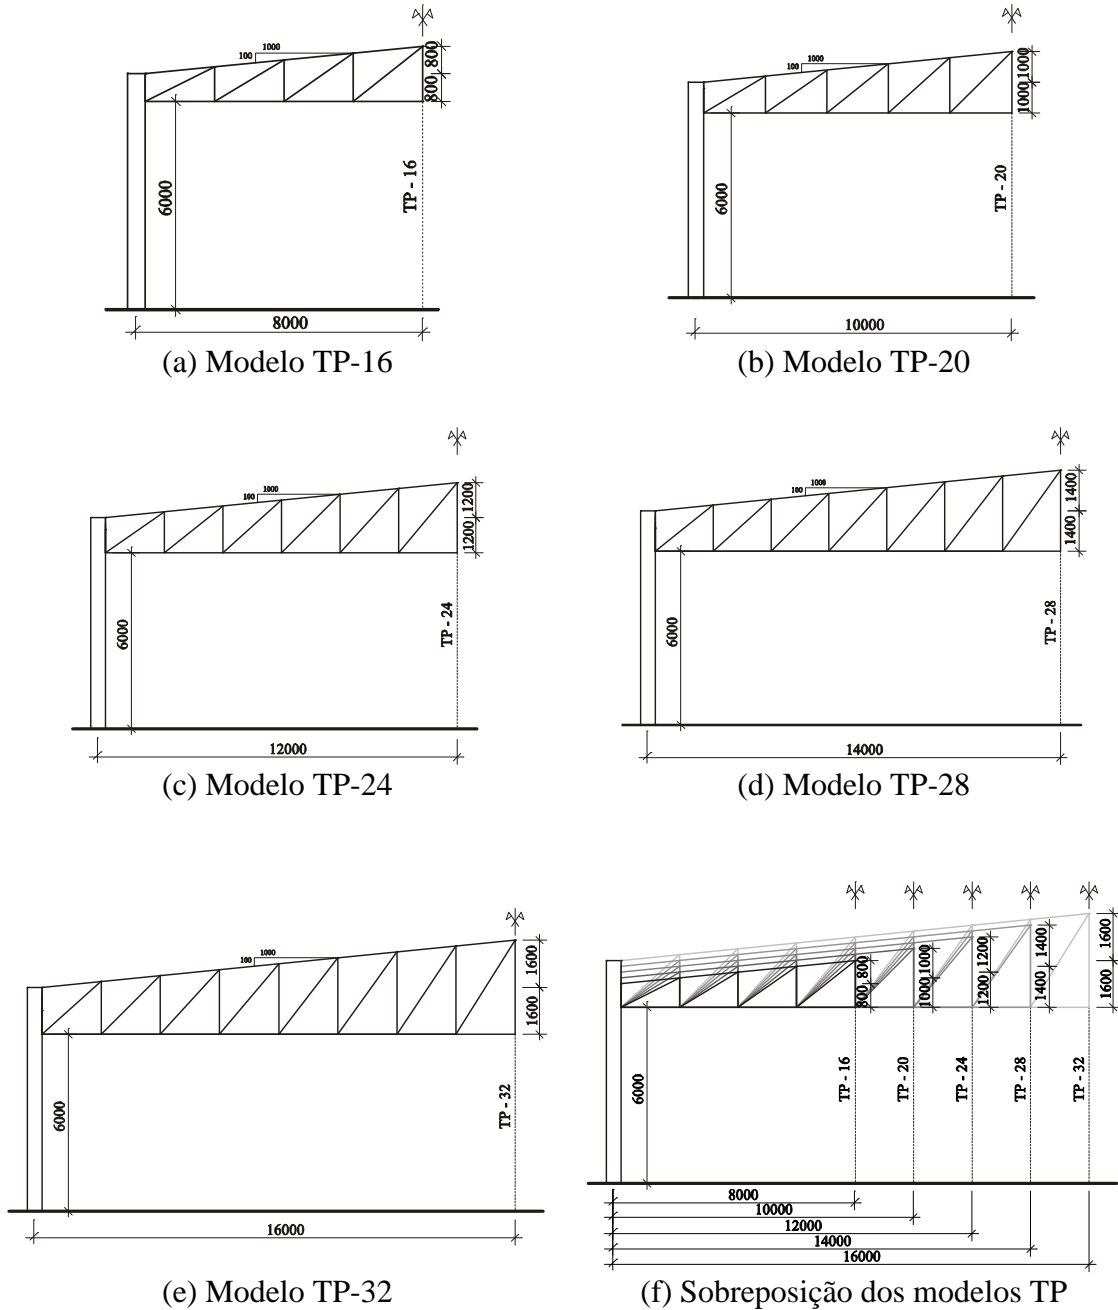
Variação da geometria para os pórticos com treliça trapezoidal (TP).
